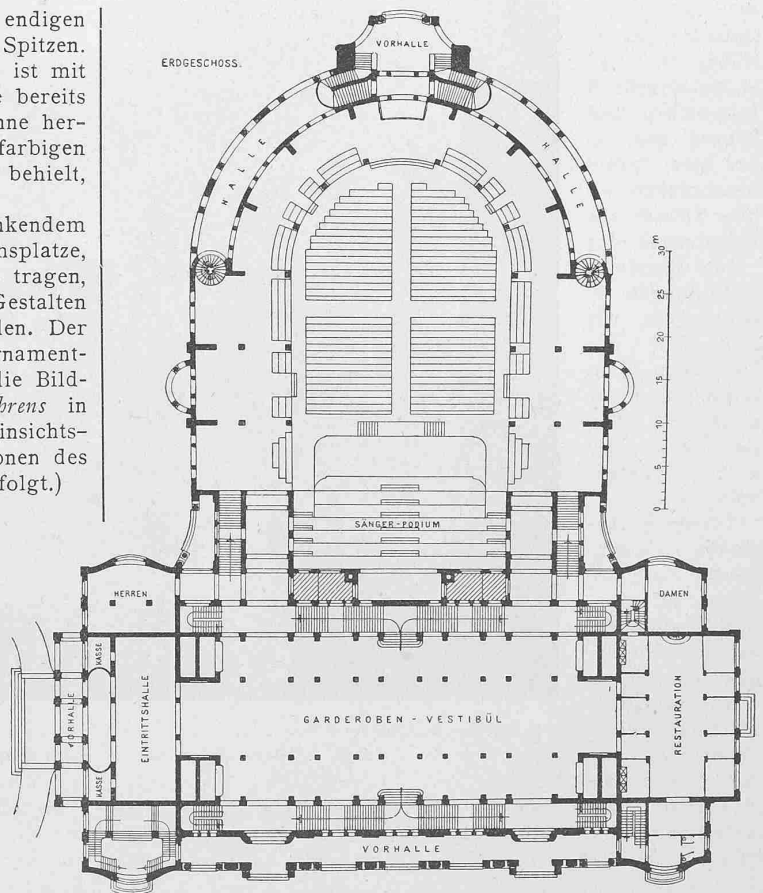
Grundriss vom Erdgeschoss. Masstab 1 : 800.
